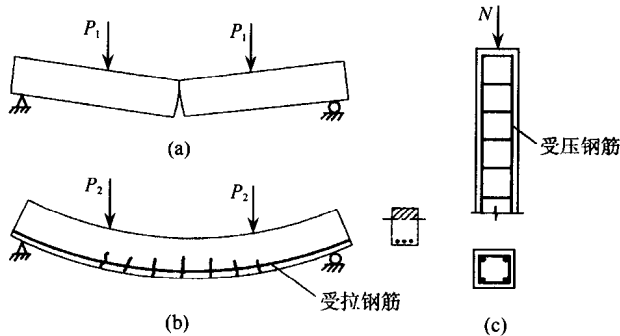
素混凝土梁及钢筋混凝土梁、柱
